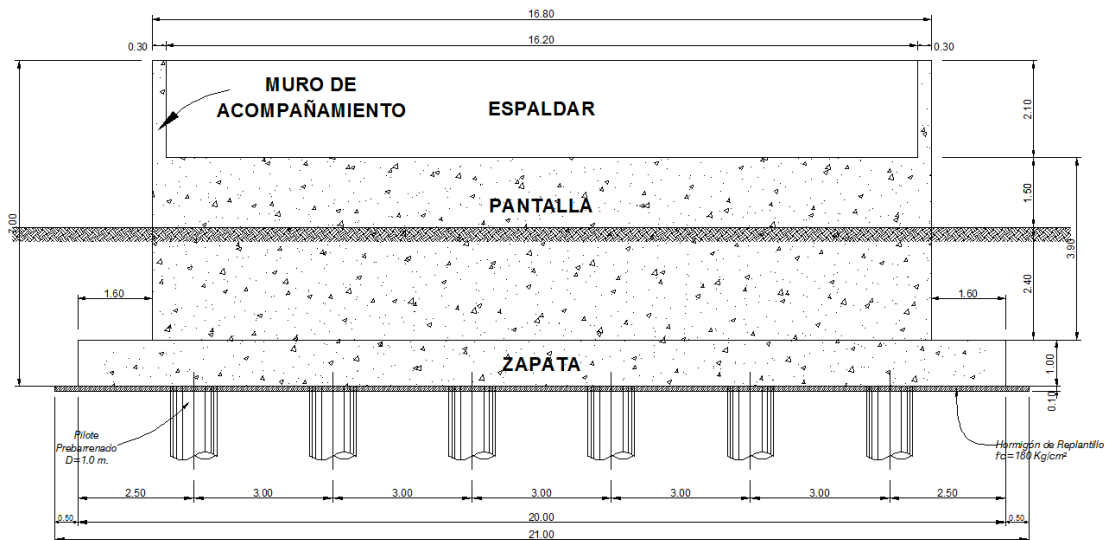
Distribución frontal de pilotes para el estribo E1.
